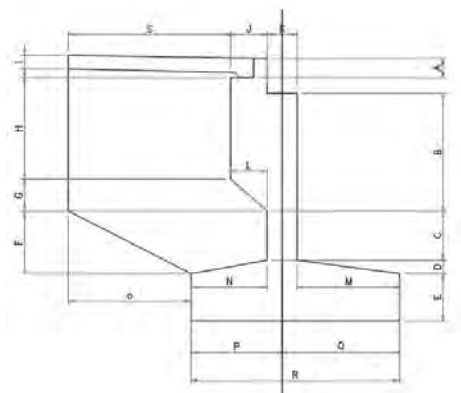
2 Pembebanan Abutment akibat beban mati bangunan atas
